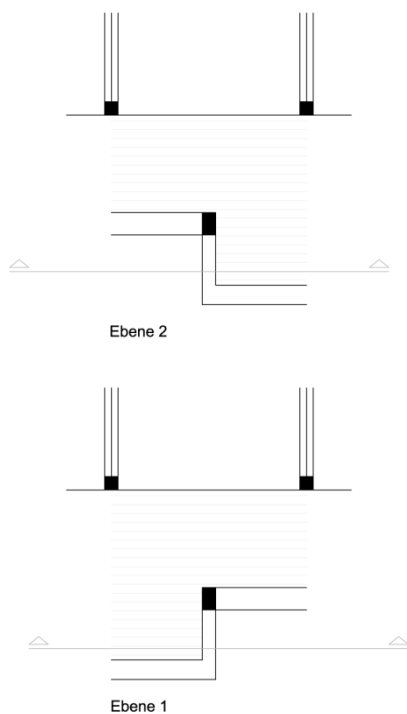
L-förmiger Balkontyp lässt zwei Zonen entstehen. In den Geschoßen darüber und darunter wird das Prinzip gespiegelt
